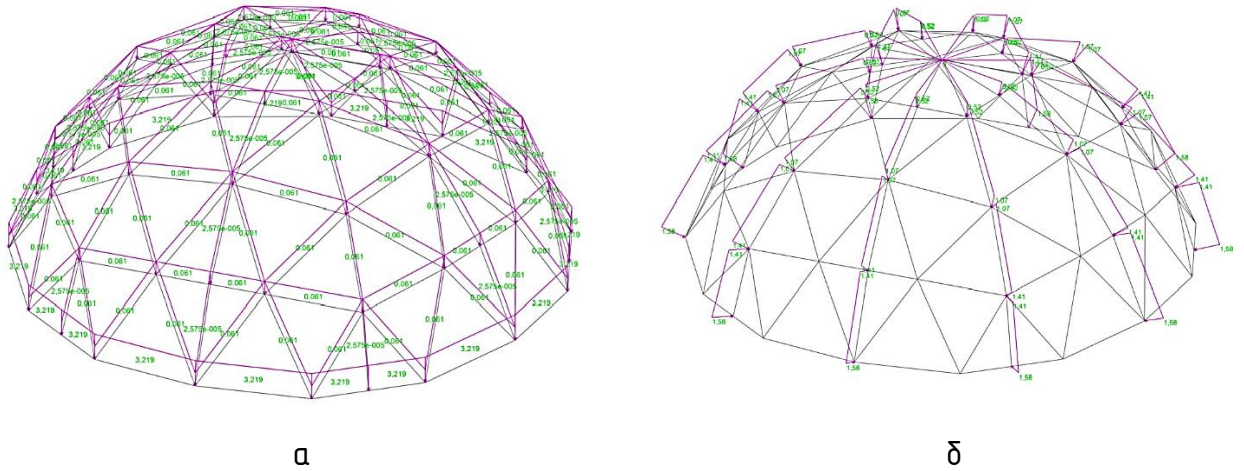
Схема загрузки купола расчетной нагрузкой: а – от собственного веса, б – от веса стекла
